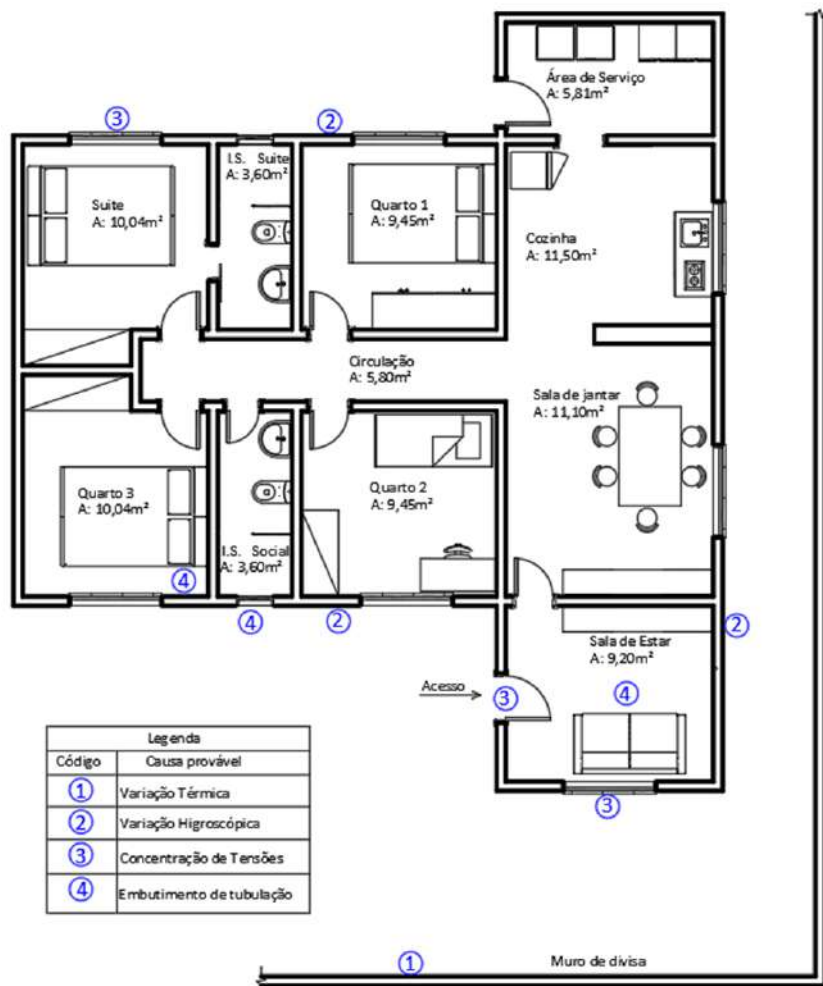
Croqui indicando os locais com as fissuras encontradas na edificação.
